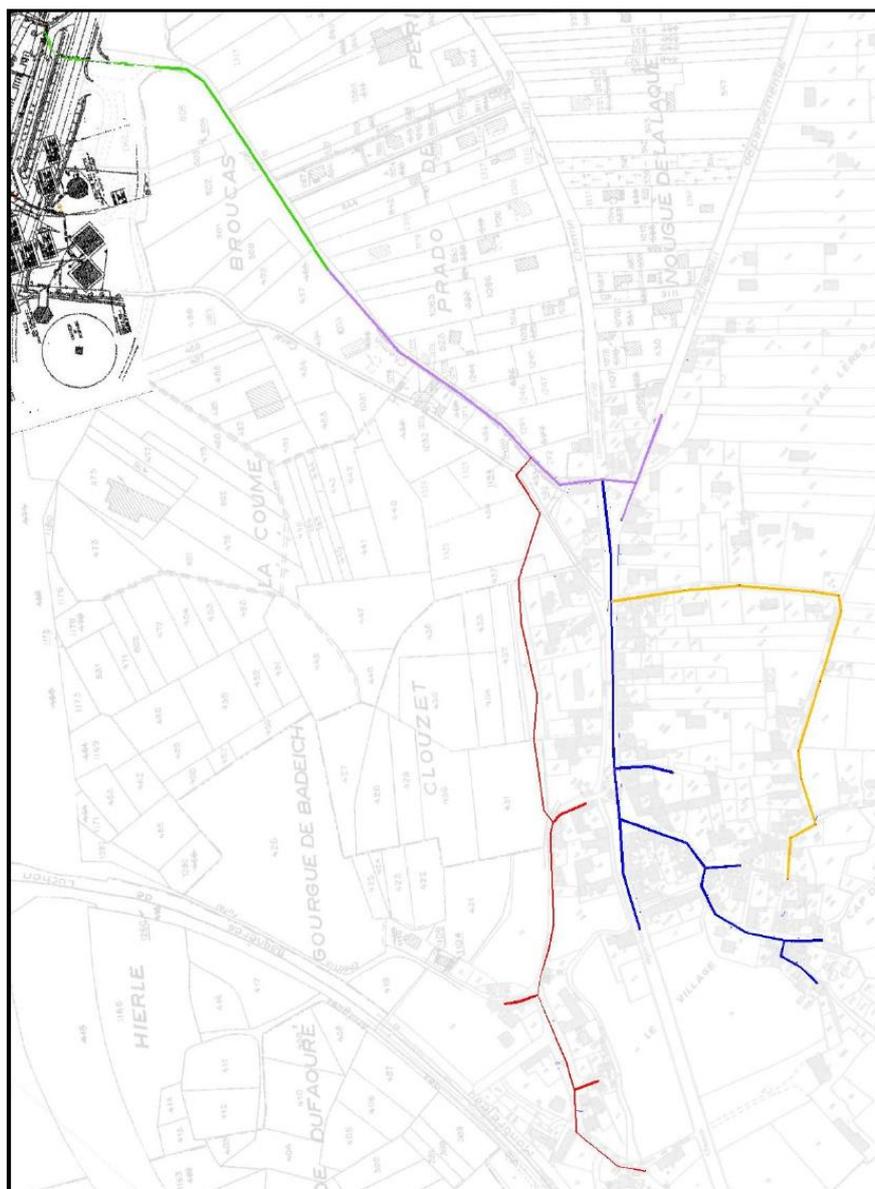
PLAN DES RESEAUX EXISTANTS
